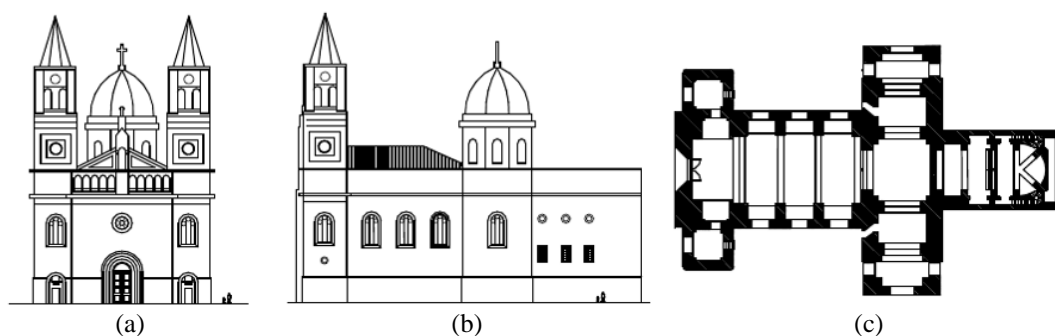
Santuário de S. Torcato: (a) fachada; (b) alçado lateral direito; (c) planta.
